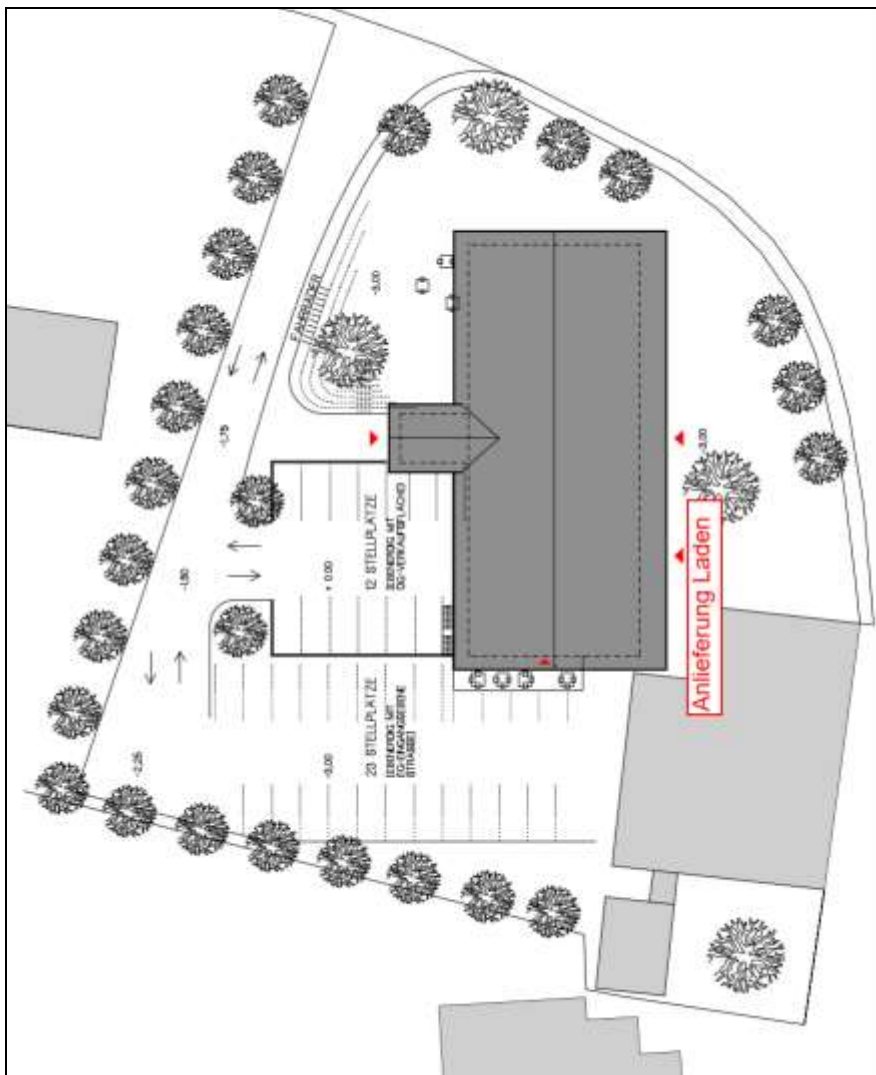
Ausschnitt Lageplan mit Planungen gemäß Vorentwurf [a]
